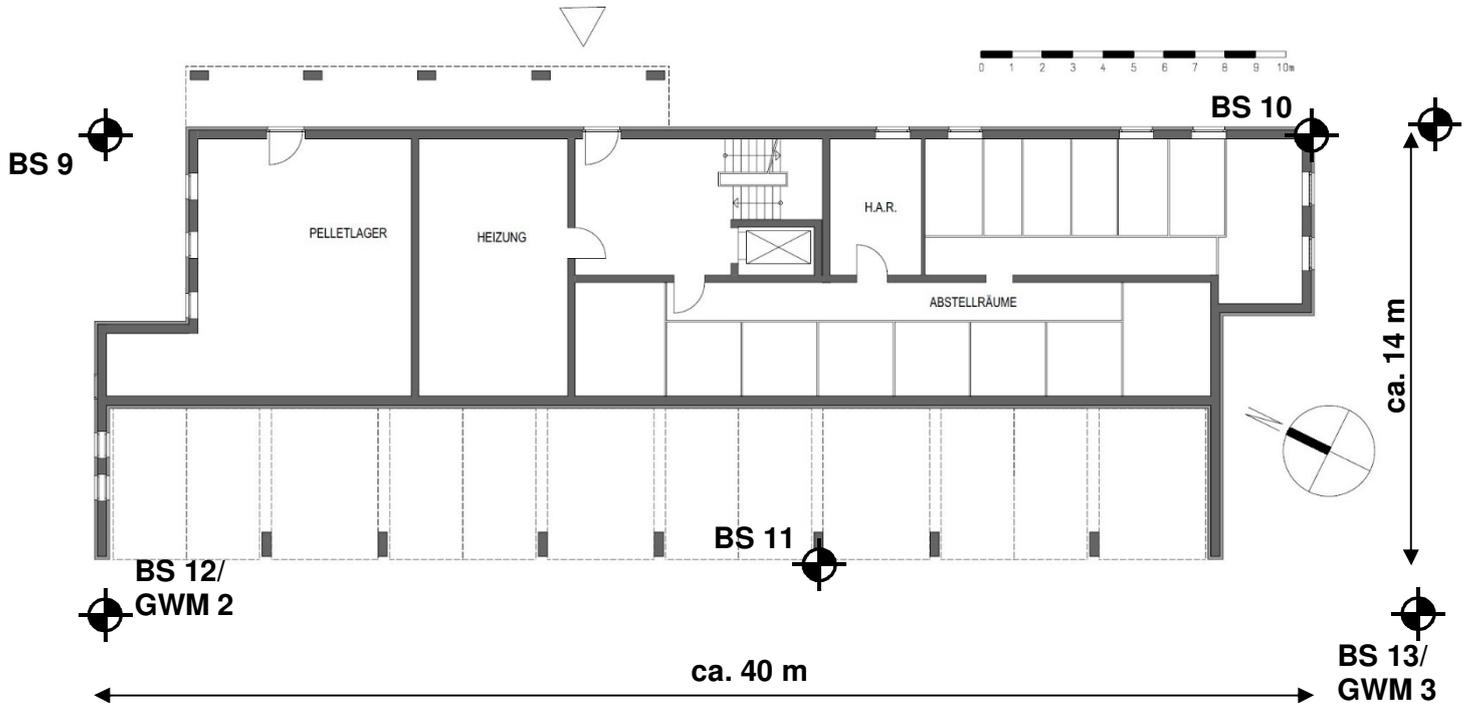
Erdgeschossgrundriss Haus 4, M 1:250
